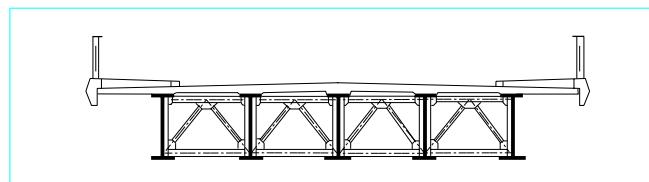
Entretoisement triangulé d'un tablier multipoutre
